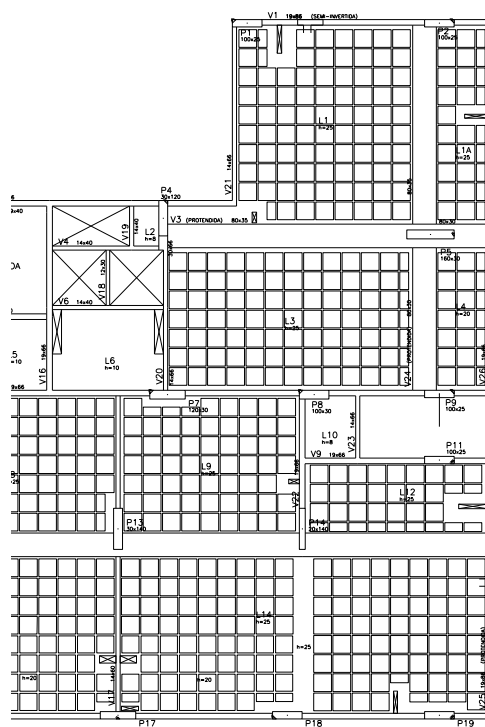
Edifício Vancouver – Vigas Faixas + Lajes Nervuradas.
